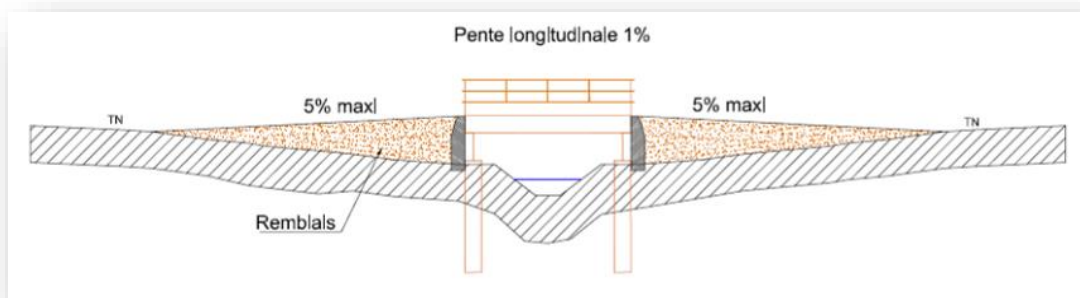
Coupe type de l'ouvrage de franchissement provisoire de l'Austreberthe
